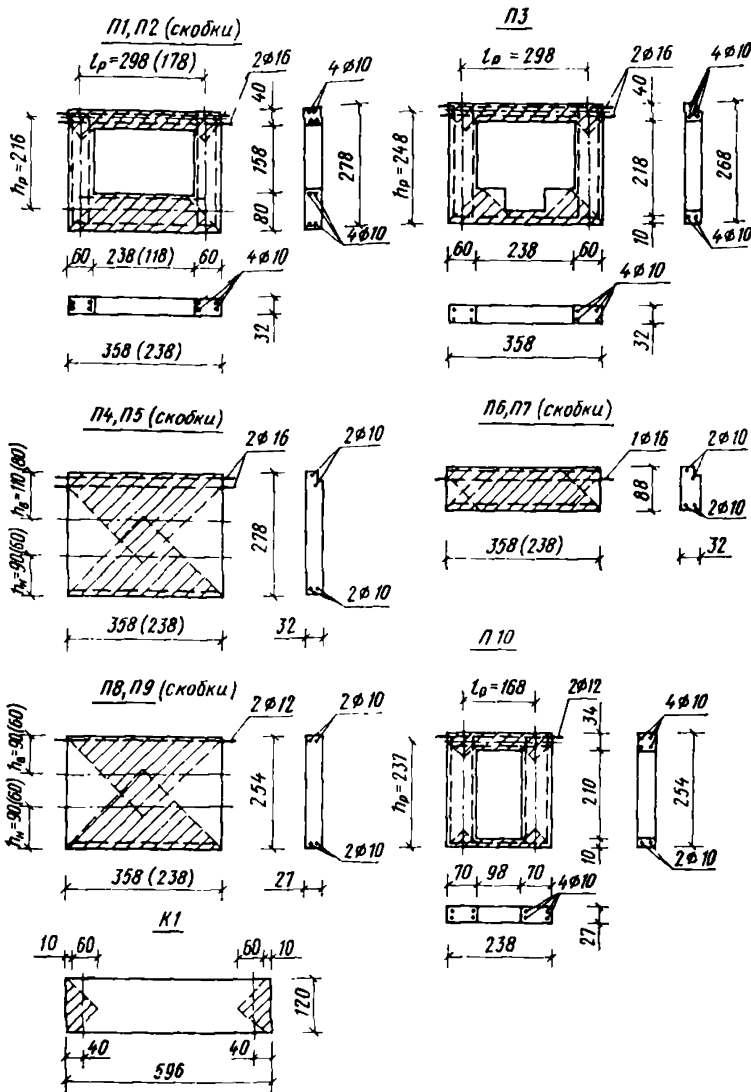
Конструкция, армирование и зоны влияния связей (штриховка) панелей наружных (П1—П5) и внутренних (П6—П9) стен
